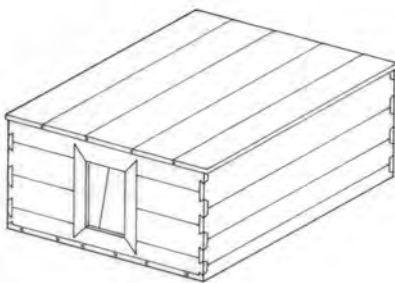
Kornkasten mit 4-eckigem Querschnitt. Zeichnung: Stefan Blum, 2003
